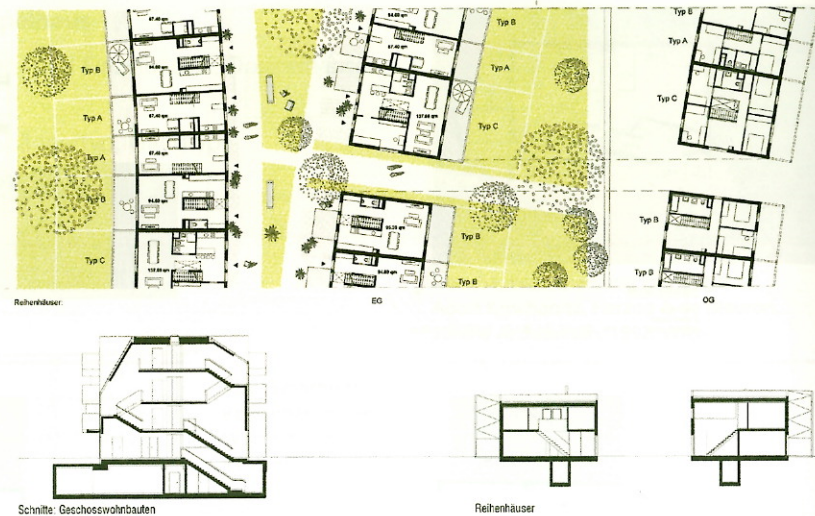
Grundriss Erdgeschoß und Schnitt
